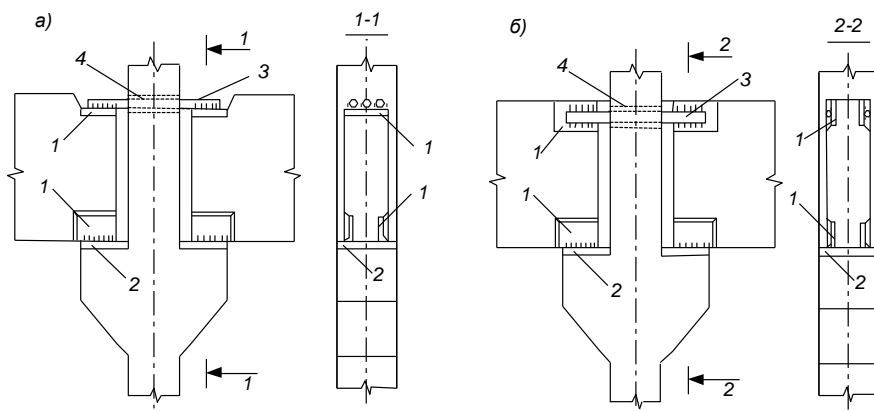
Узлы соединения ригеля с колонной:
